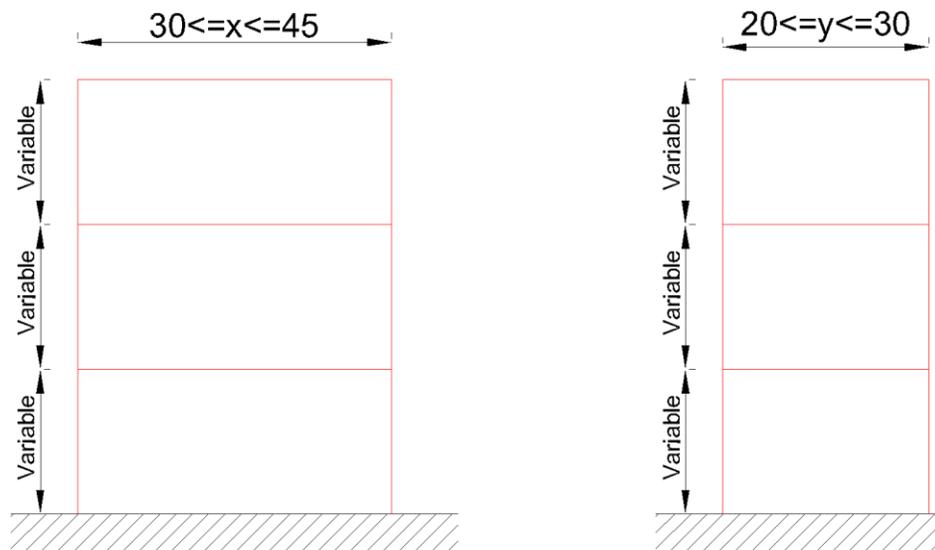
Vistas en elevación del edificio. (Dimensiones en cm)
